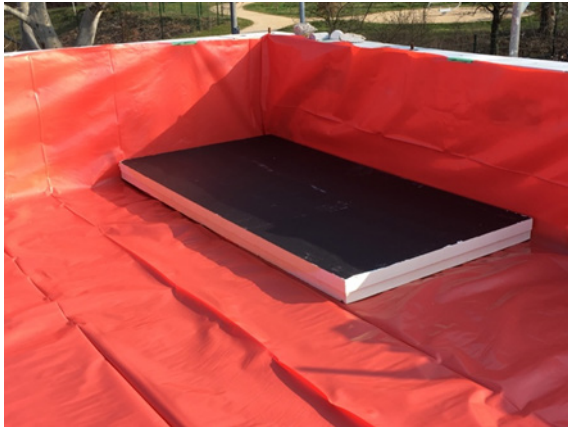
Grunddämmung auf Dampfsperre-Dachaufbau
